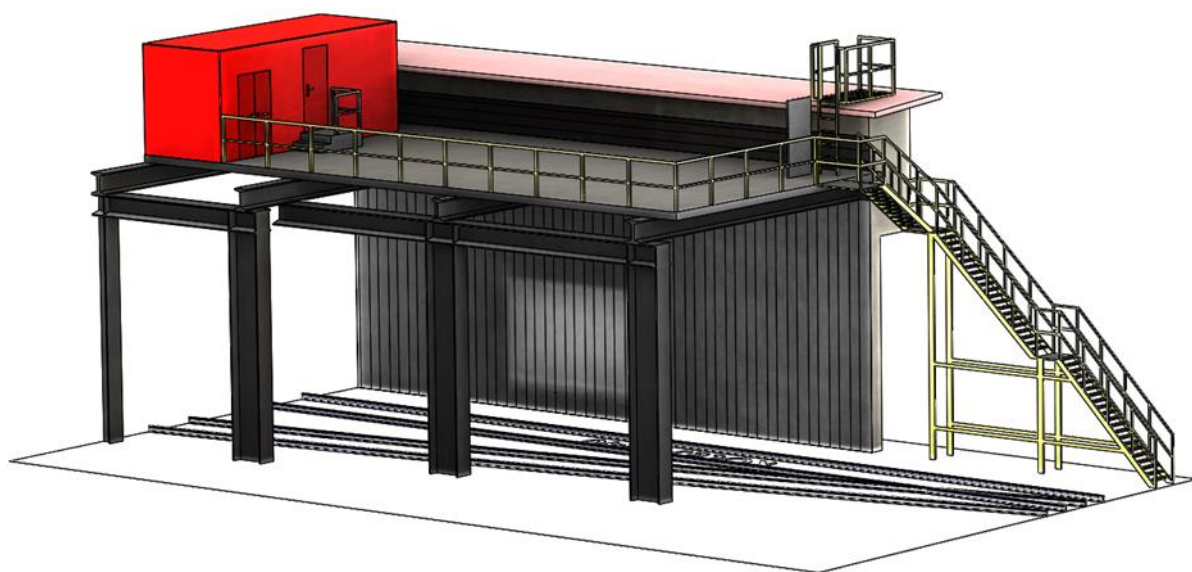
Odsávací digestoře pro odprašování zdroje „C“
